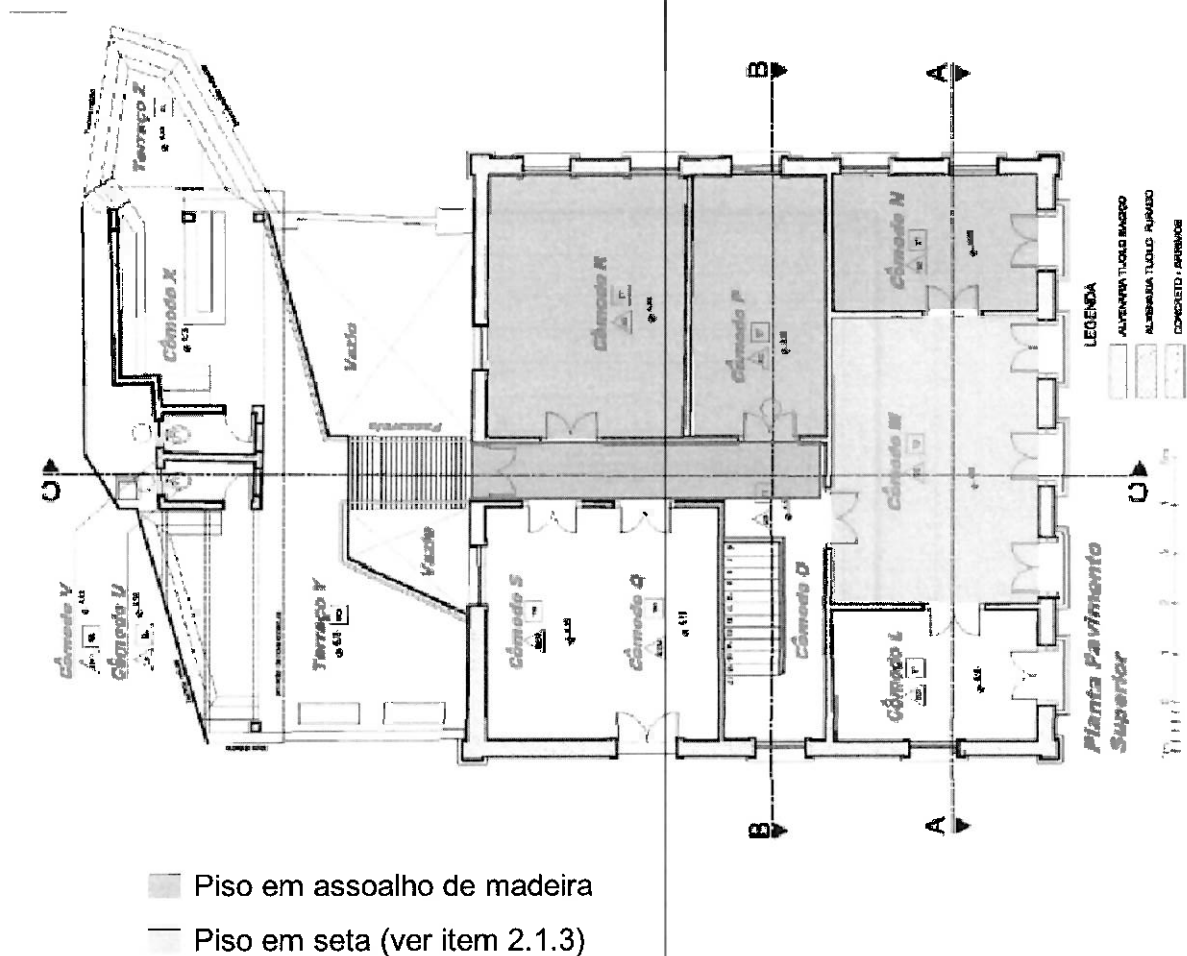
FIG.: Planta do primeiro pavimento com demarcações de piso de assoalho de madeira resgatados.
